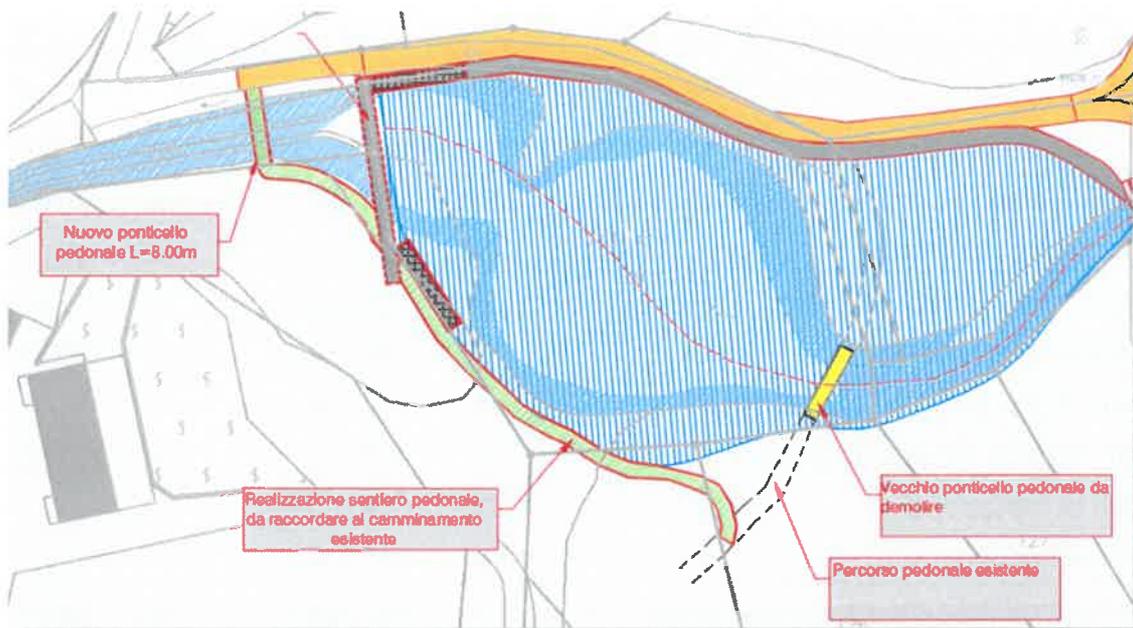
Estratto planimetria di progetto con nuovo ponticello e tracciato del nuovo sentiero (in verde)
